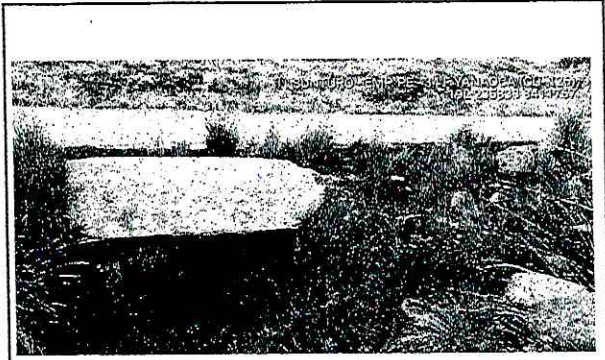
ALCANTARILLA DE CONCRETO 96+780
